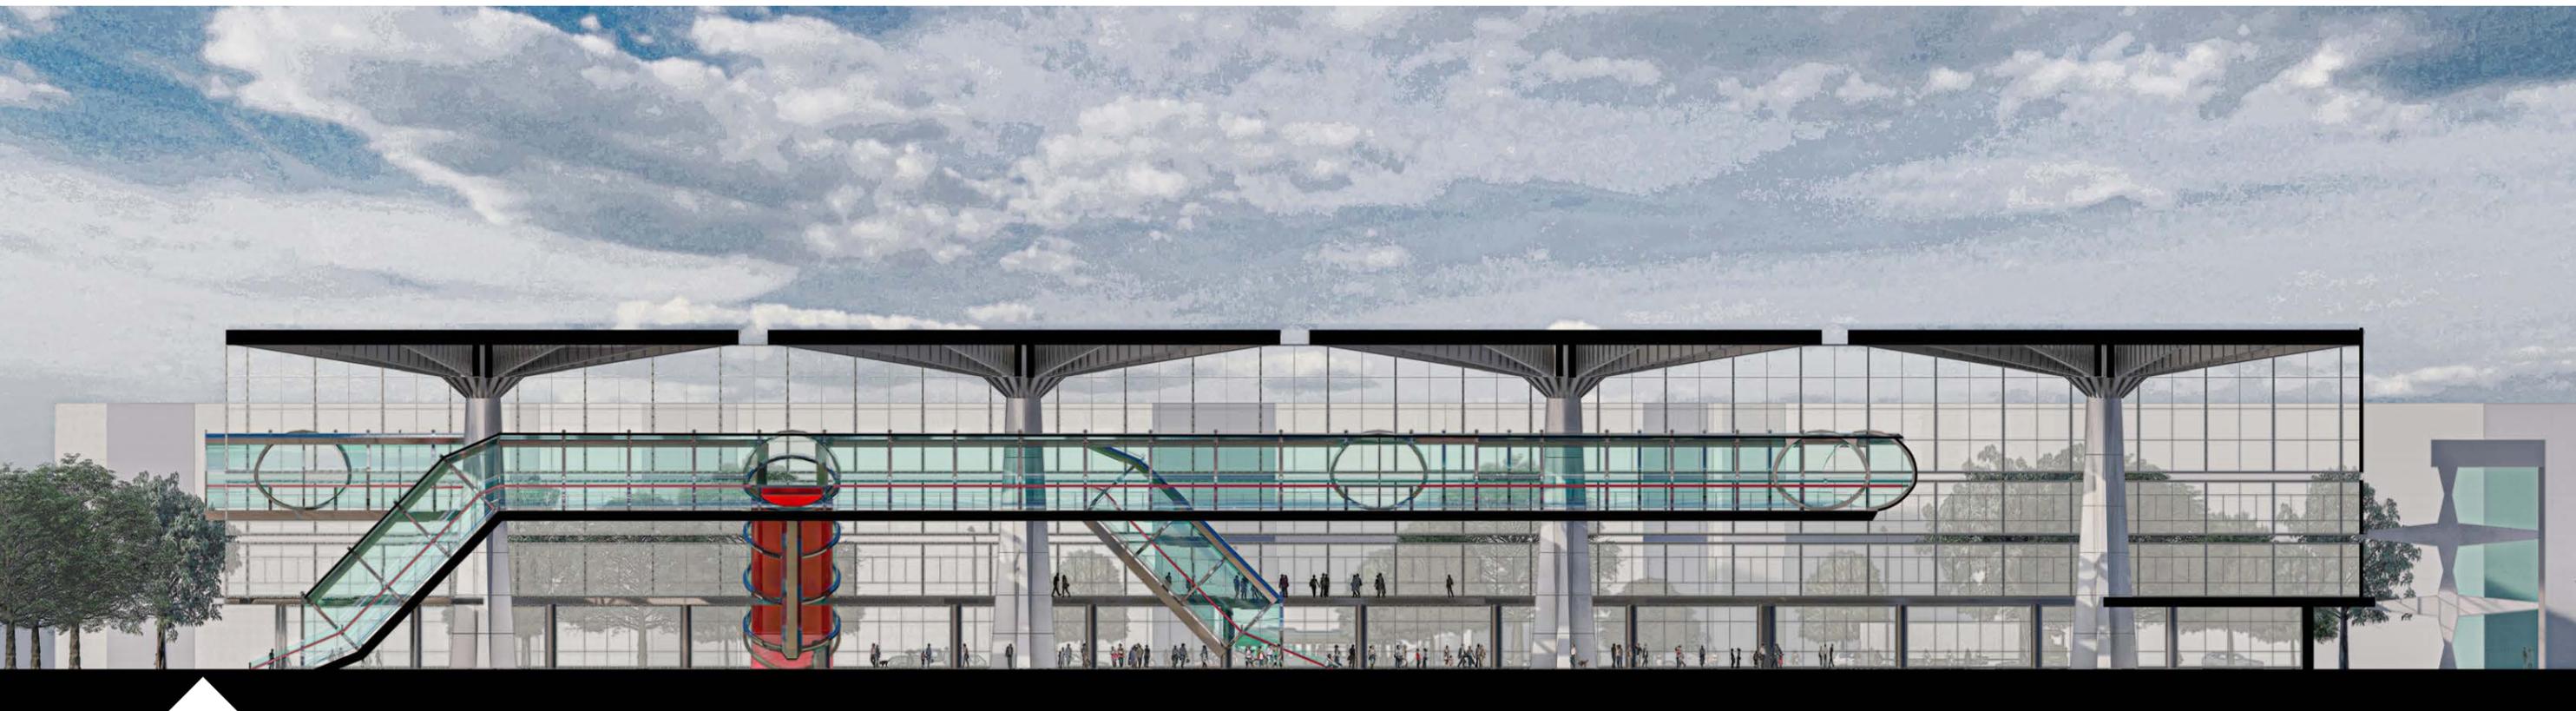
Sezione dell'ipotesi di progetto avanzato nello scenario, elaborato degli autori.
